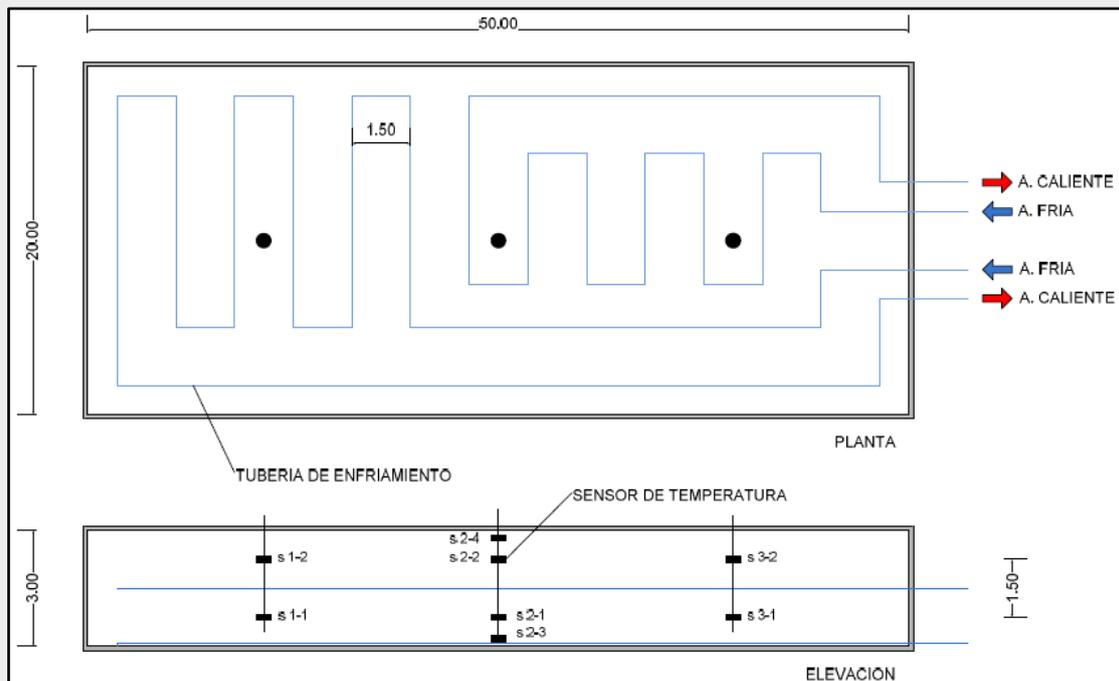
Esquema de distribución de la tubería de post enfriamiento del concreto [27].
